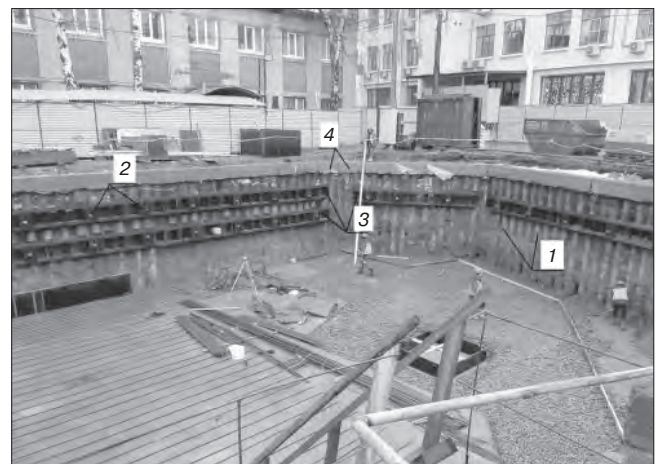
Фрагмент плана ограждения котлована: 1 – буринъекционные сваи ЭРТ; 2 – грунтовые анкера ЭРТ; 3 – анкерный обвязочный пояс; 4 – монолитный железобетонный обвязочный пояс
